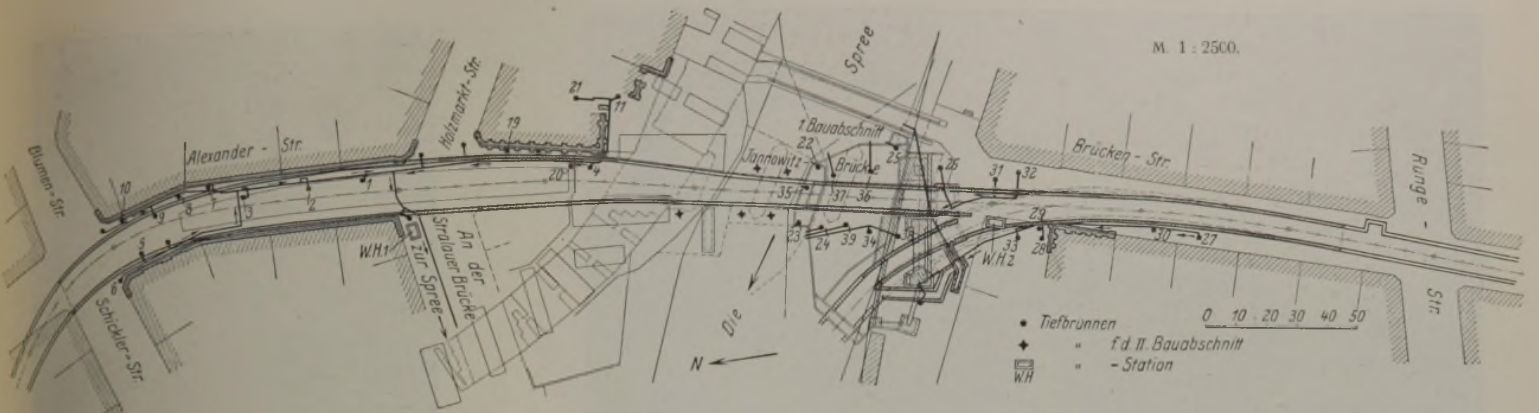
Schnellbahn Gesundbrunnen—Neukölln, Los XIX, Spreetunnel. Lageplan der Baustelle mit Eintragung der Tiefbrunnenanlage.
